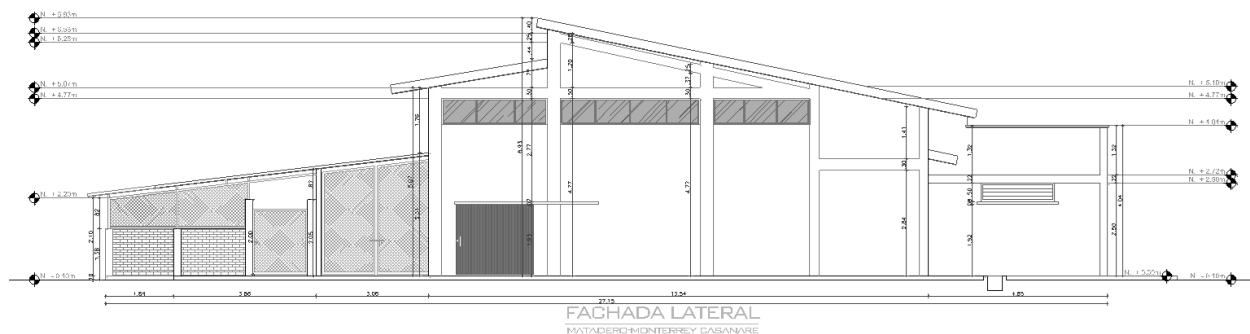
Fachada lateral. Fuente: Elaborado por el autor.
